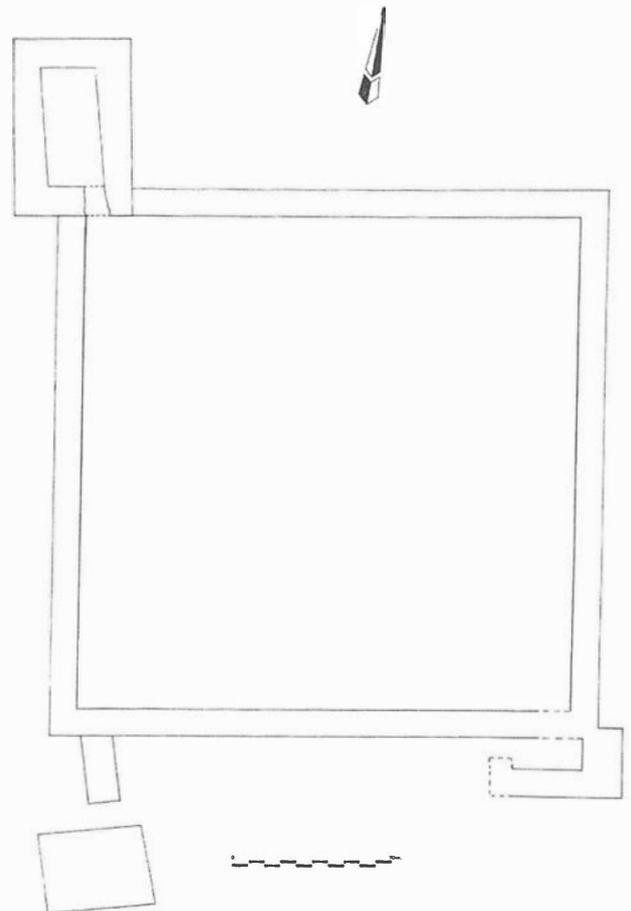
Planimetría general de la fortificación "Torre Cartagena".
